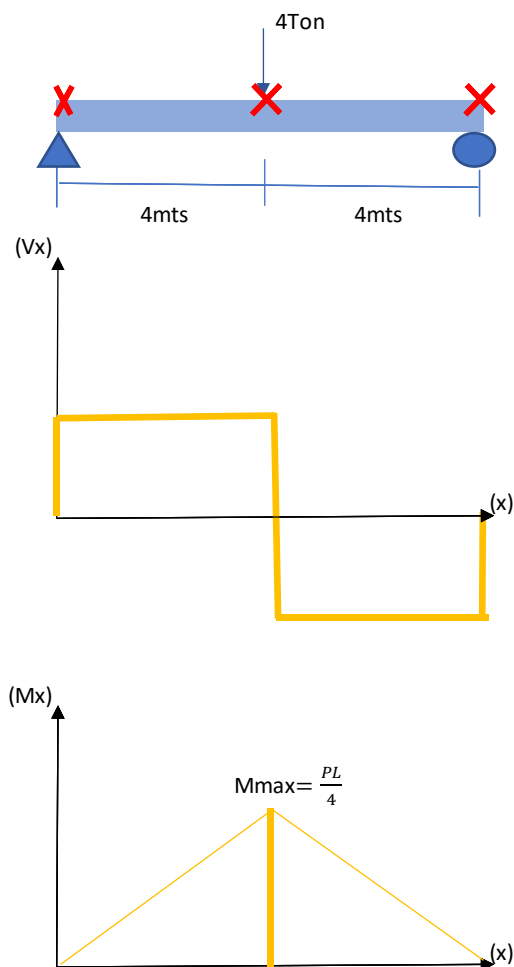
Caso 3, Viga de entrespacio simplemente apoyada con carga puntual y un Lb de 4mts. Fuente: propia
